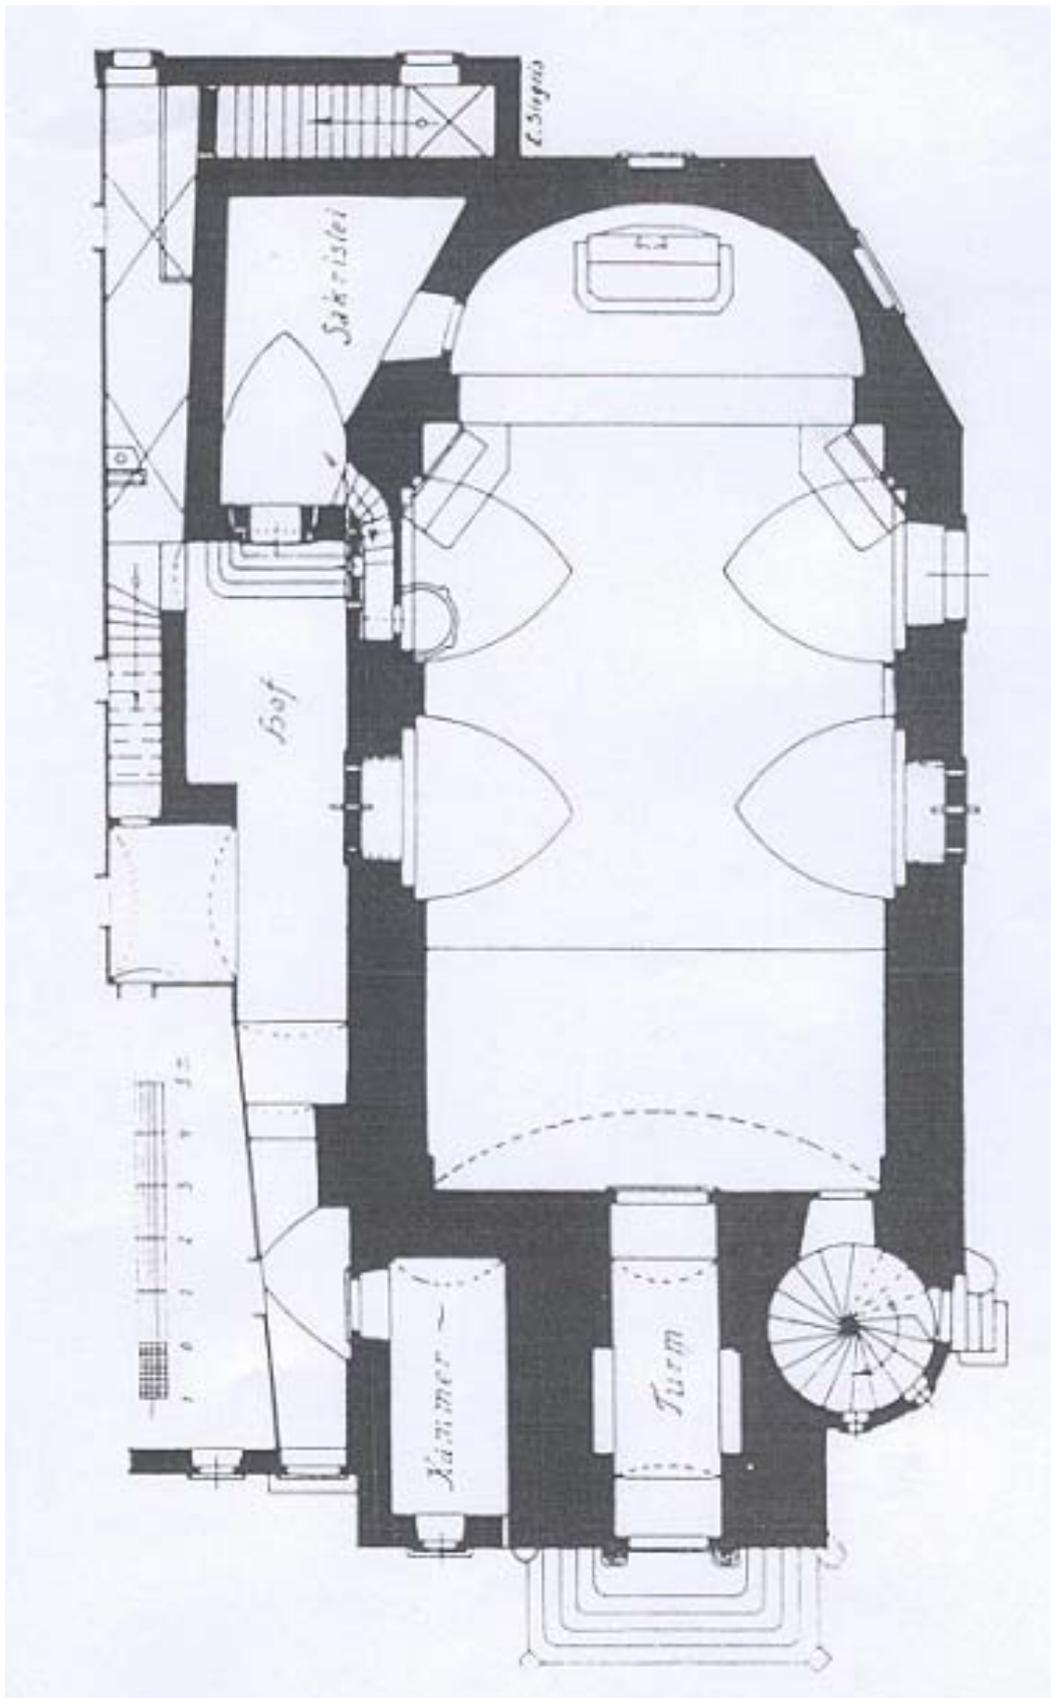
, Grundriss 7, Rust, Pfarrkirche³²⁹
